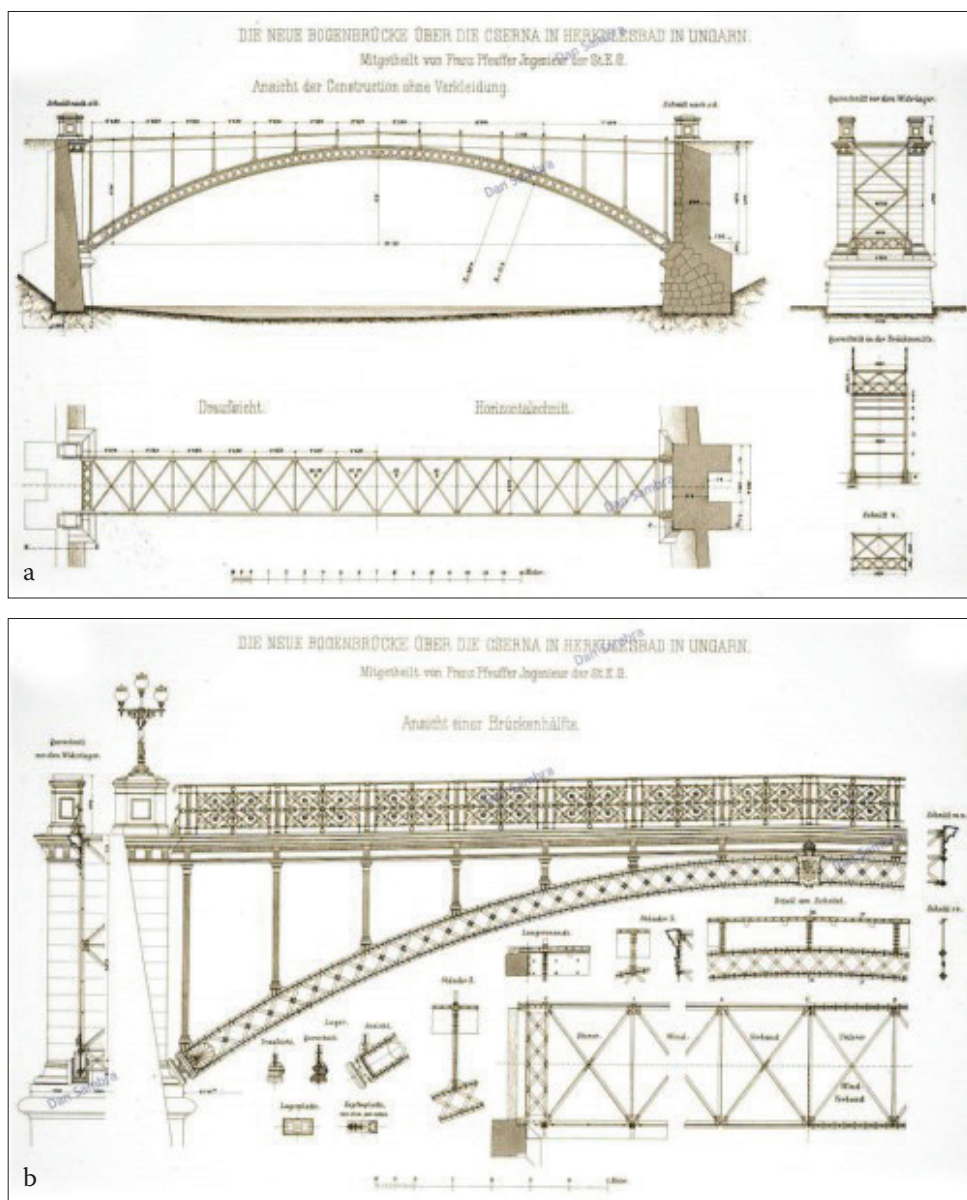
a - b. Băile Herculanene (jud. Caraș-Severin) a) Elevation, secțiune orizontală și verticală a podului pietonal construit între 1883 - 1886; b) Detaliu de proiect (după *Allgemeine Bauzeitung mit Abbildungen*, Wien 1889)
